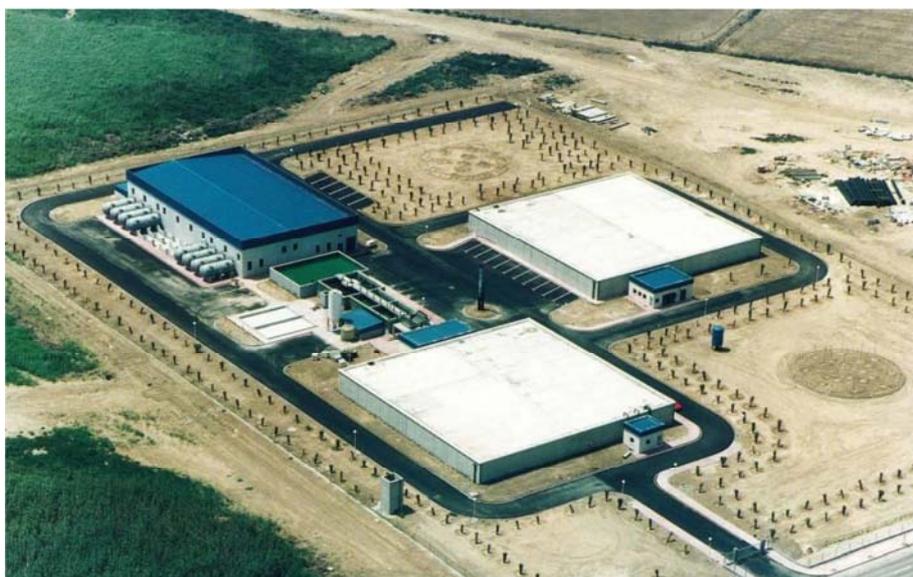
Vista general de la Planta Desalobradora de El Mojón
